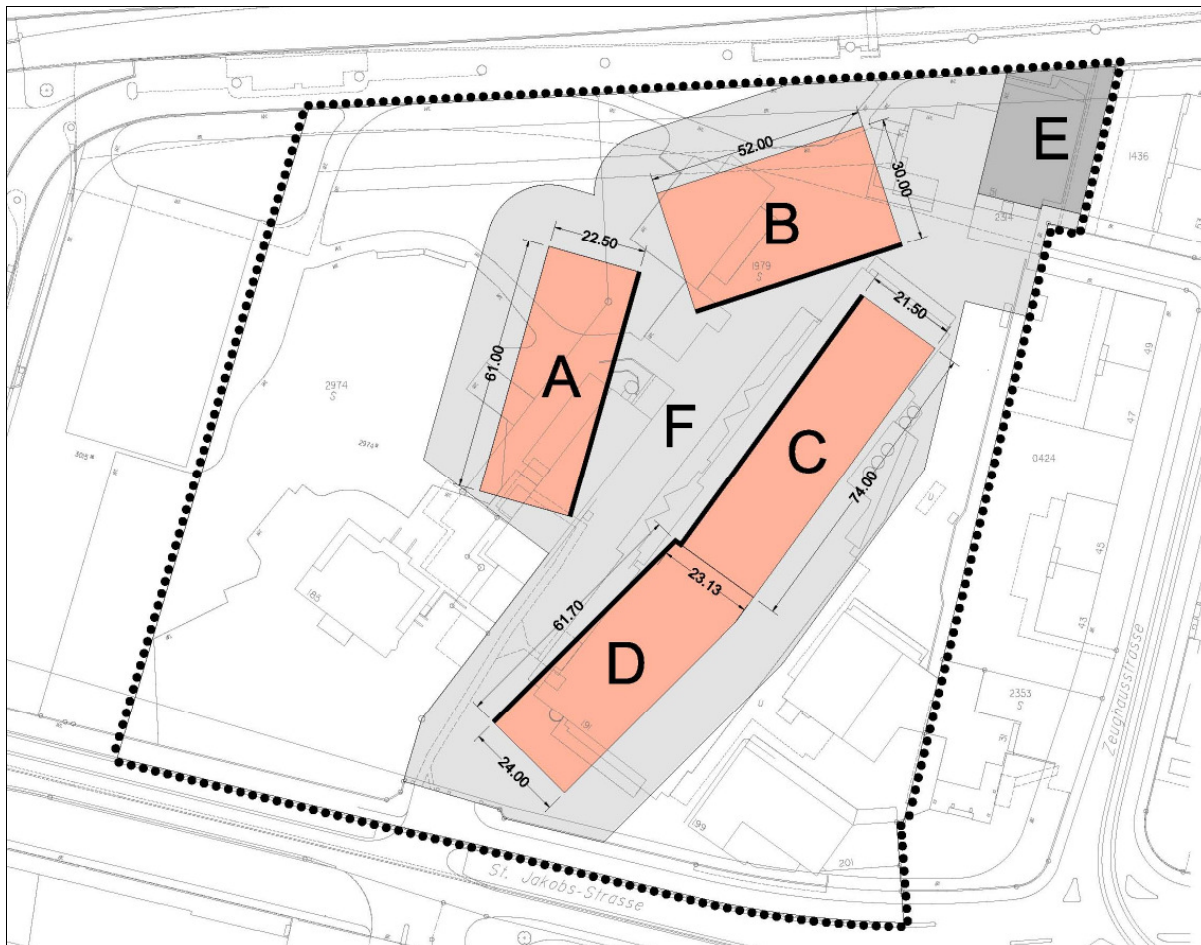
Bebauungsplan, Plan Nr. 13'221. (Nicht massstäblich, Plan genordet)
